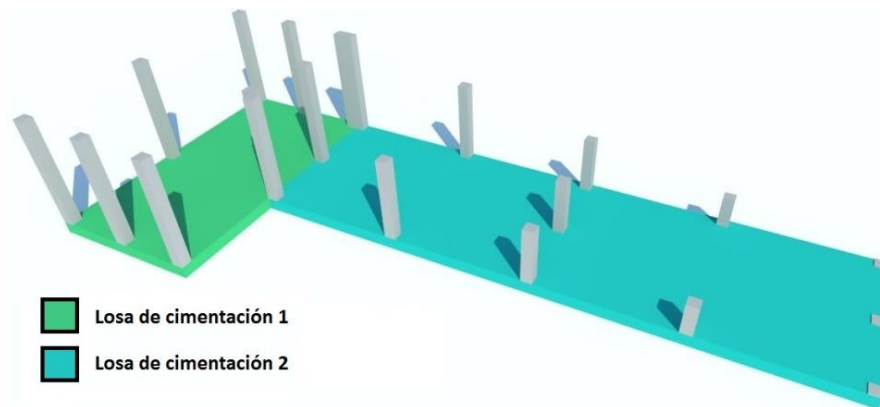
Losa de cimentación para rampa de acceso
